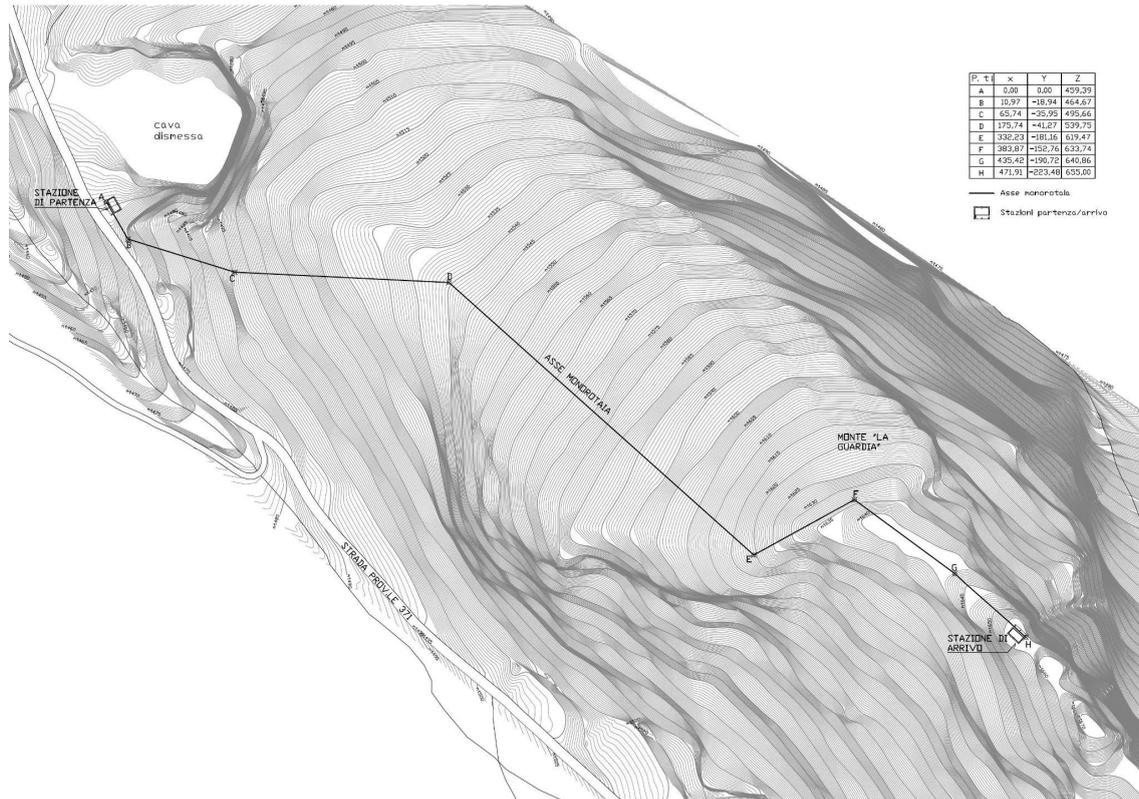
Sistema di trasporto con monorotaia, Planimetria generale di progetto¹³⁶
